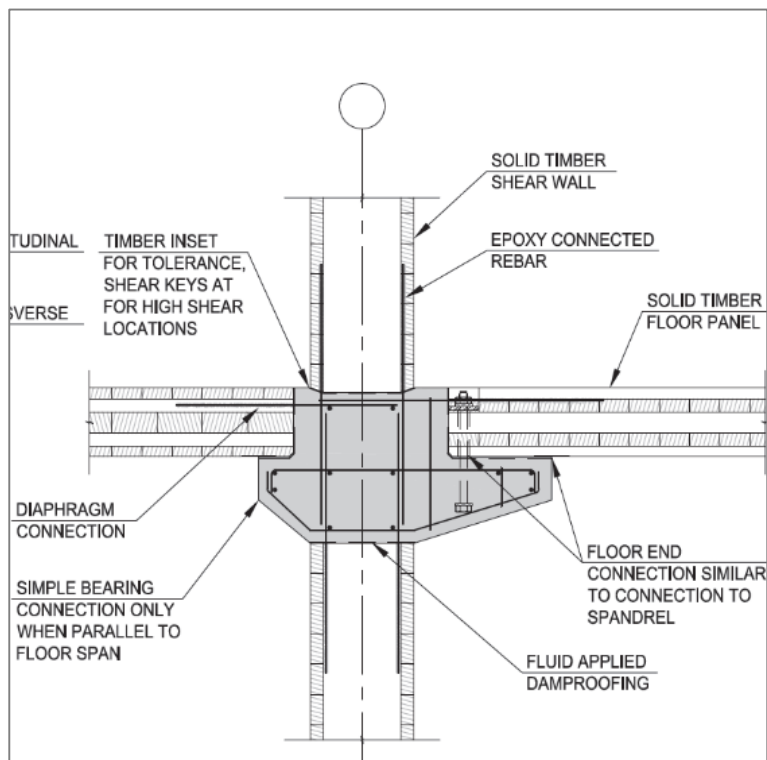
Pormenor da viga de betão que fixa a estrutura de madeira
